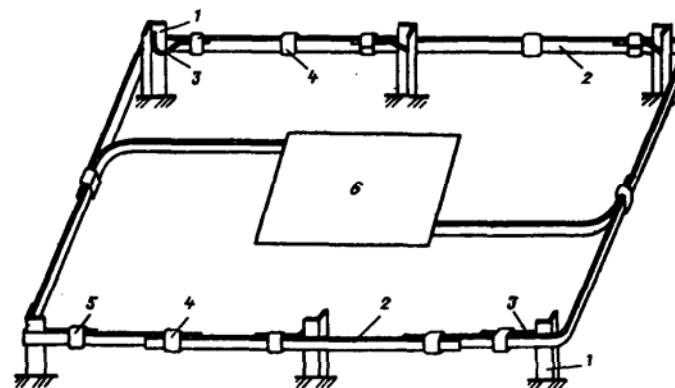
Общий вид заземляющего устройства, выполненного методом термитной сварки:
